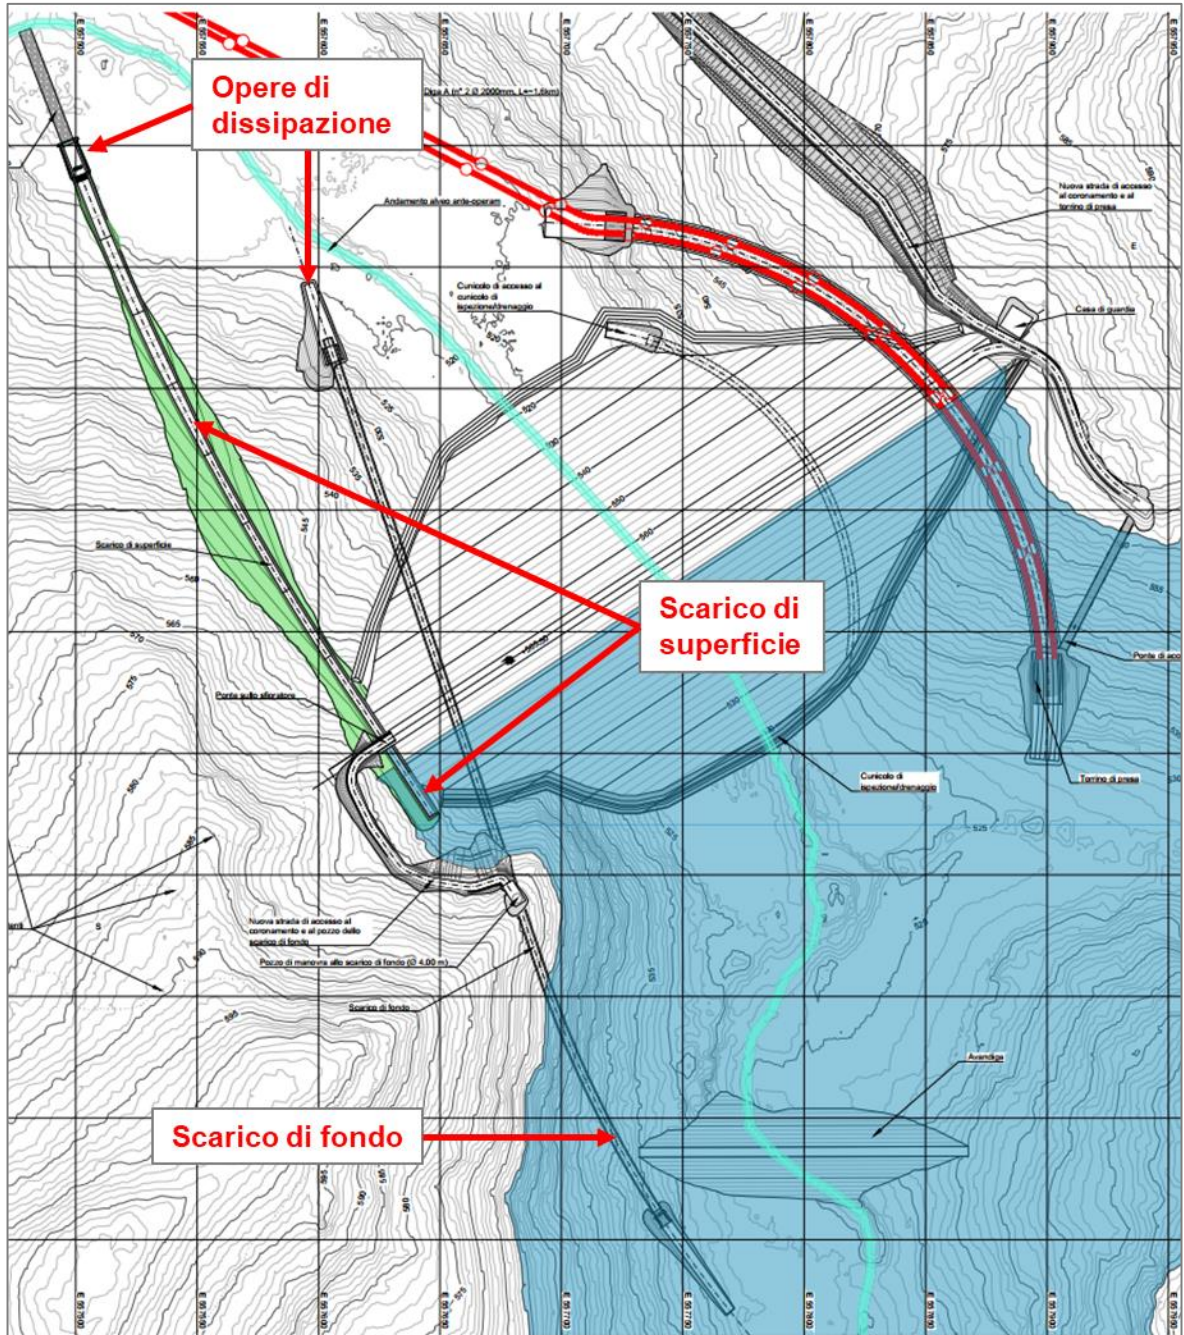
Alternativa 2 e 3: planimetria di inquadramento della Diga D
